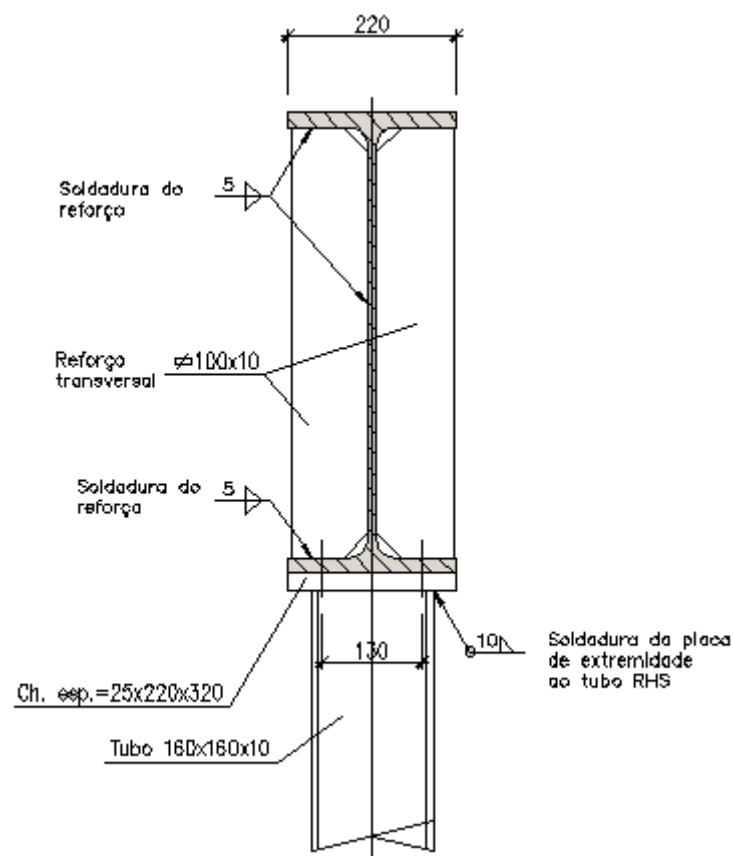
Ligação viga-pilar articulada, com viga suportada directamente pelo pilar (Cima Gomes; Biscaia, N., 2008)
